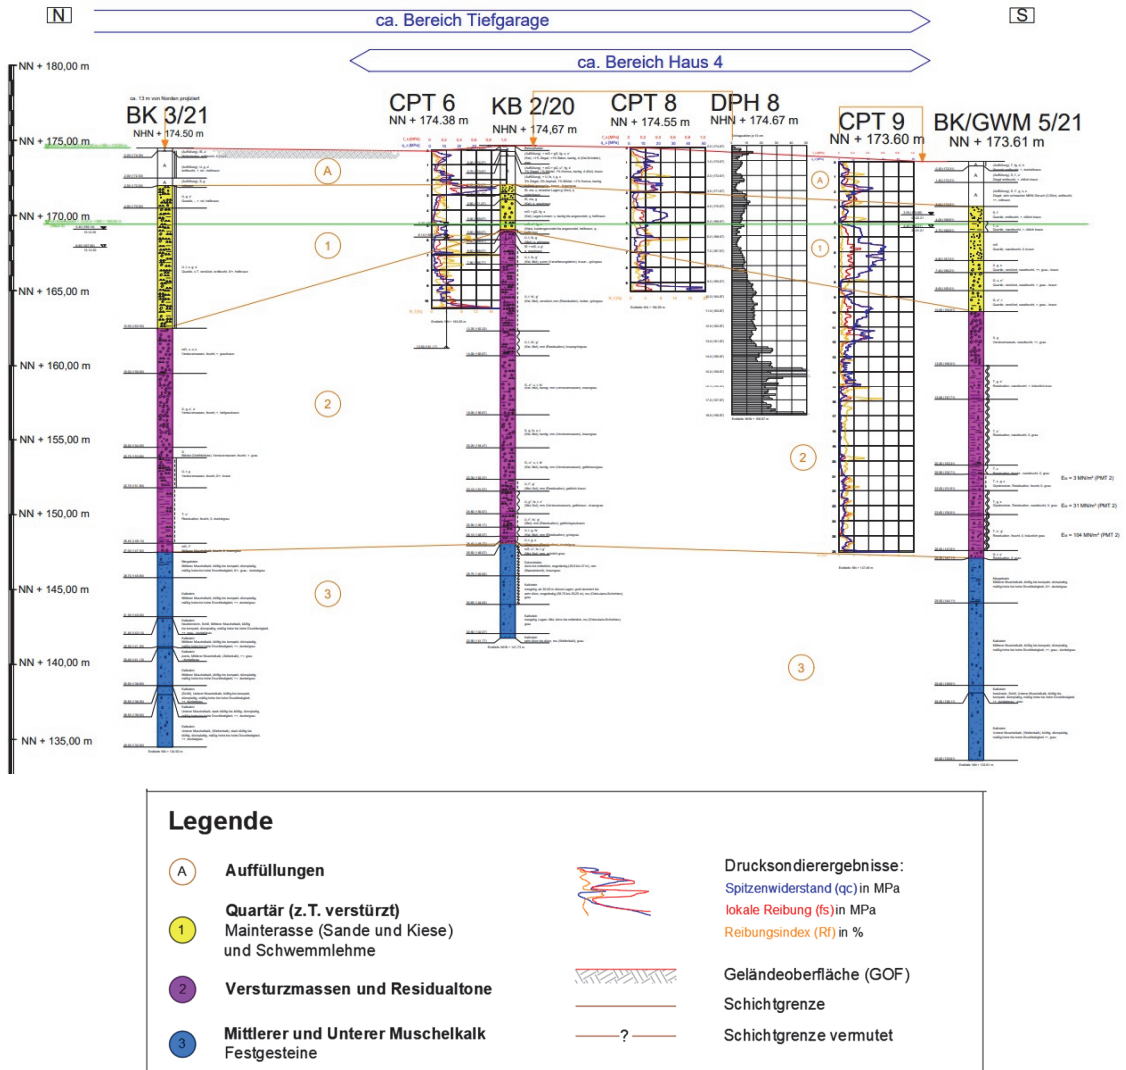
Baugrundschnitt VI – VI mit den Ergebnissen der ergänzenden Baugrunderkundung (auszugsweise im Bereich Haus 4)
